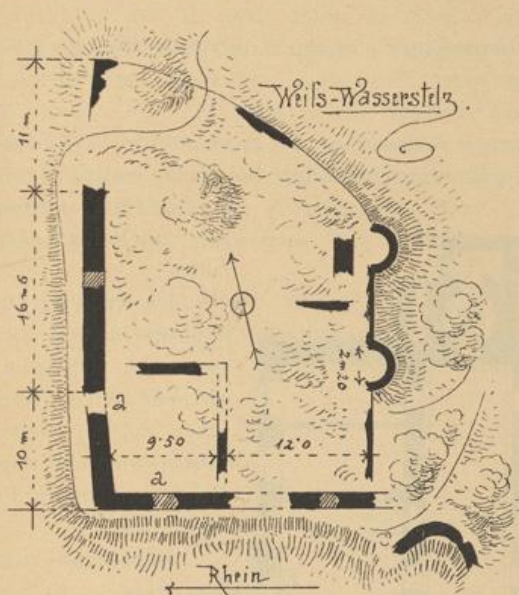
Weisswasserstels. Grundriss der Burg. II.
